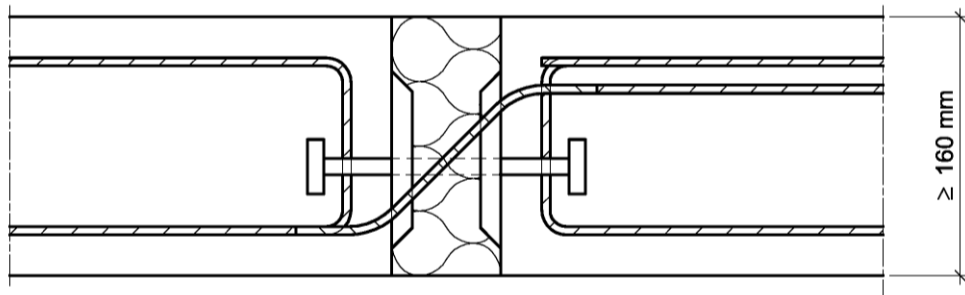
Beispiel Schöck Isokorb[®] Typ Q mit Vertikalbewehrung
